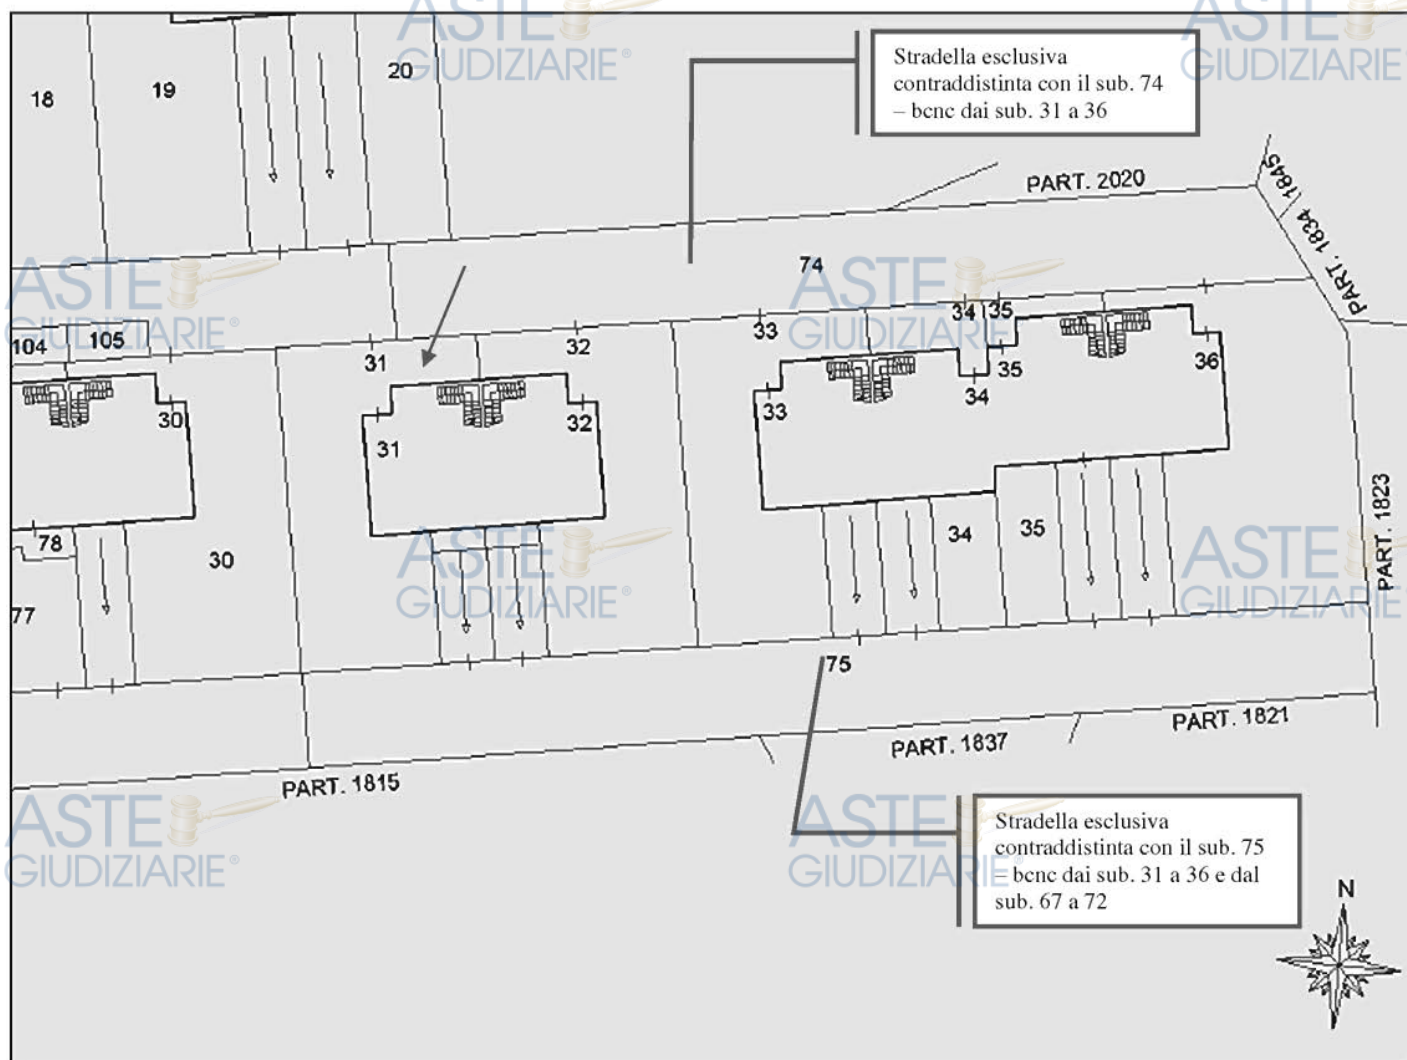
Visualizzazione dei beni oggetto della presente sezione- piano terra
